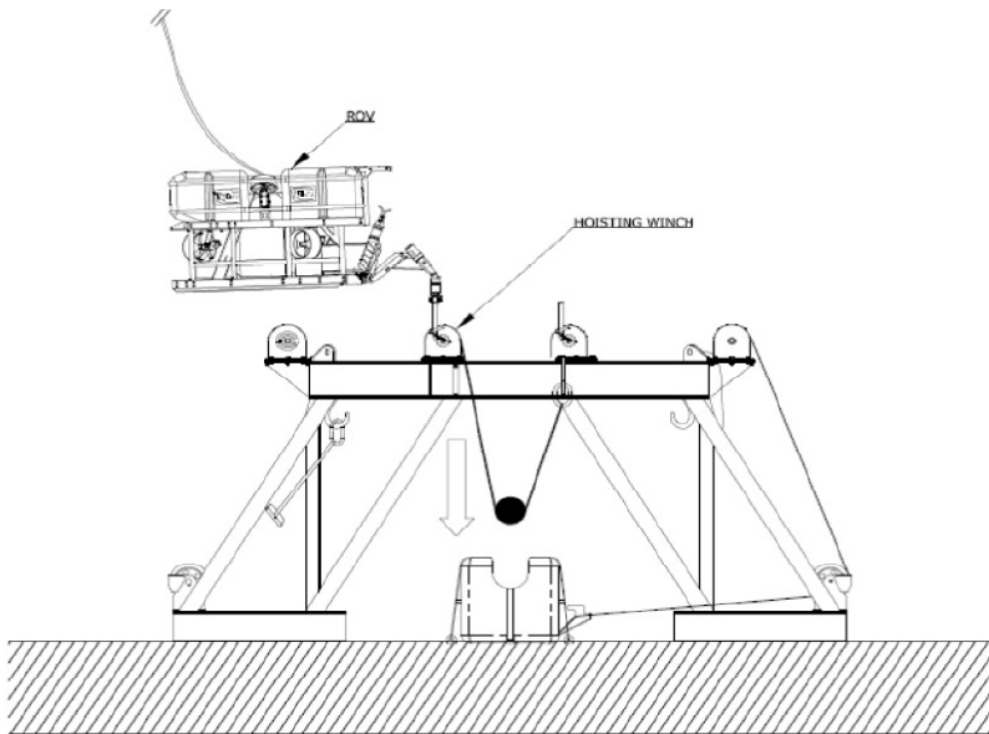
ROV conecta o cabo guincho de movimentação no Grout Bag.
